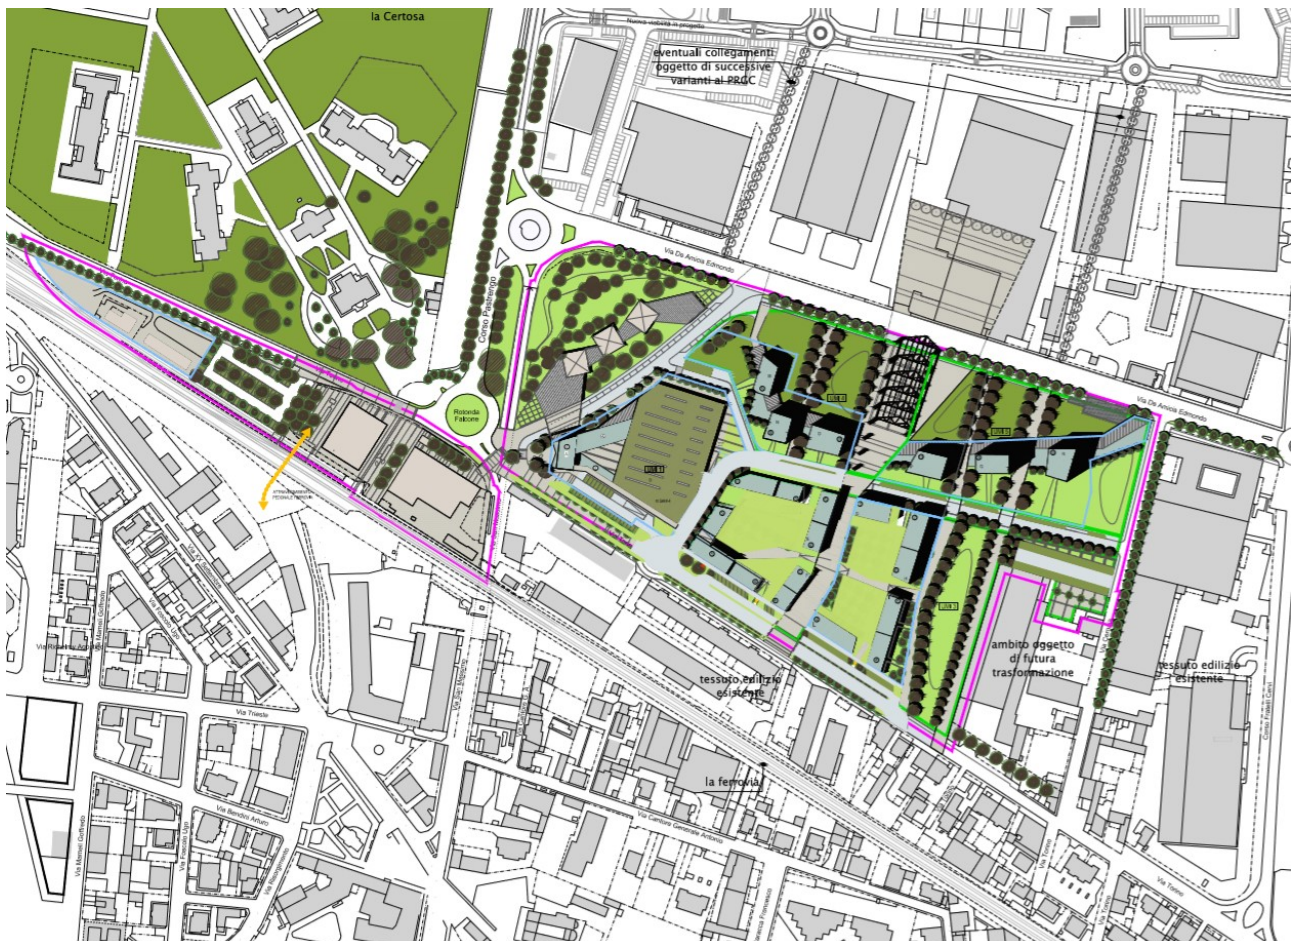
assetto viario di progetto (Fonte: Masterplan Arch. Picco)
